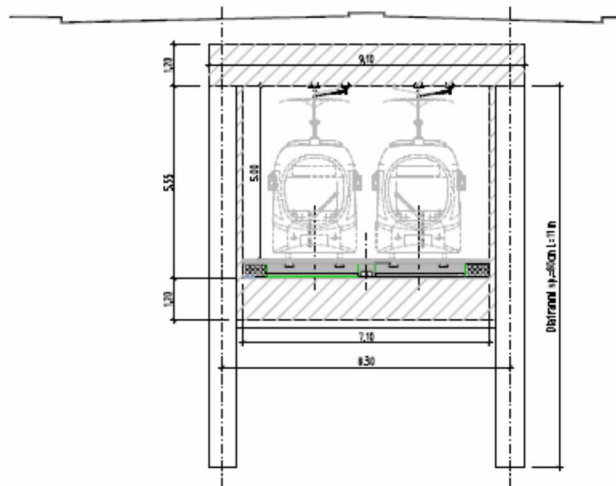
Sezione trasversale sottopasso (estratto da elaborato B831-C-SF-STR-RT002A)
